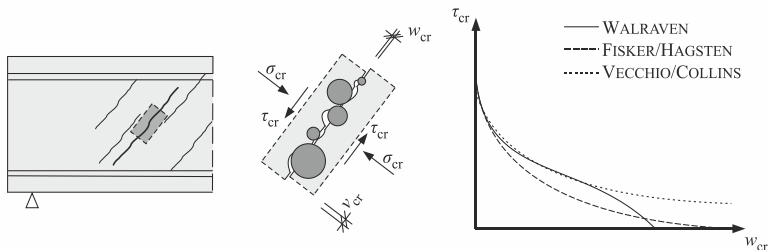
Rissreibung und Kraftübertragung über Risse im unbewehrten Beton (links) und Schubspannungs-Rissöffnungs-Beziehungen nach [Wal-1980], [Vec-1986], [Fis-2016] (rechts)
